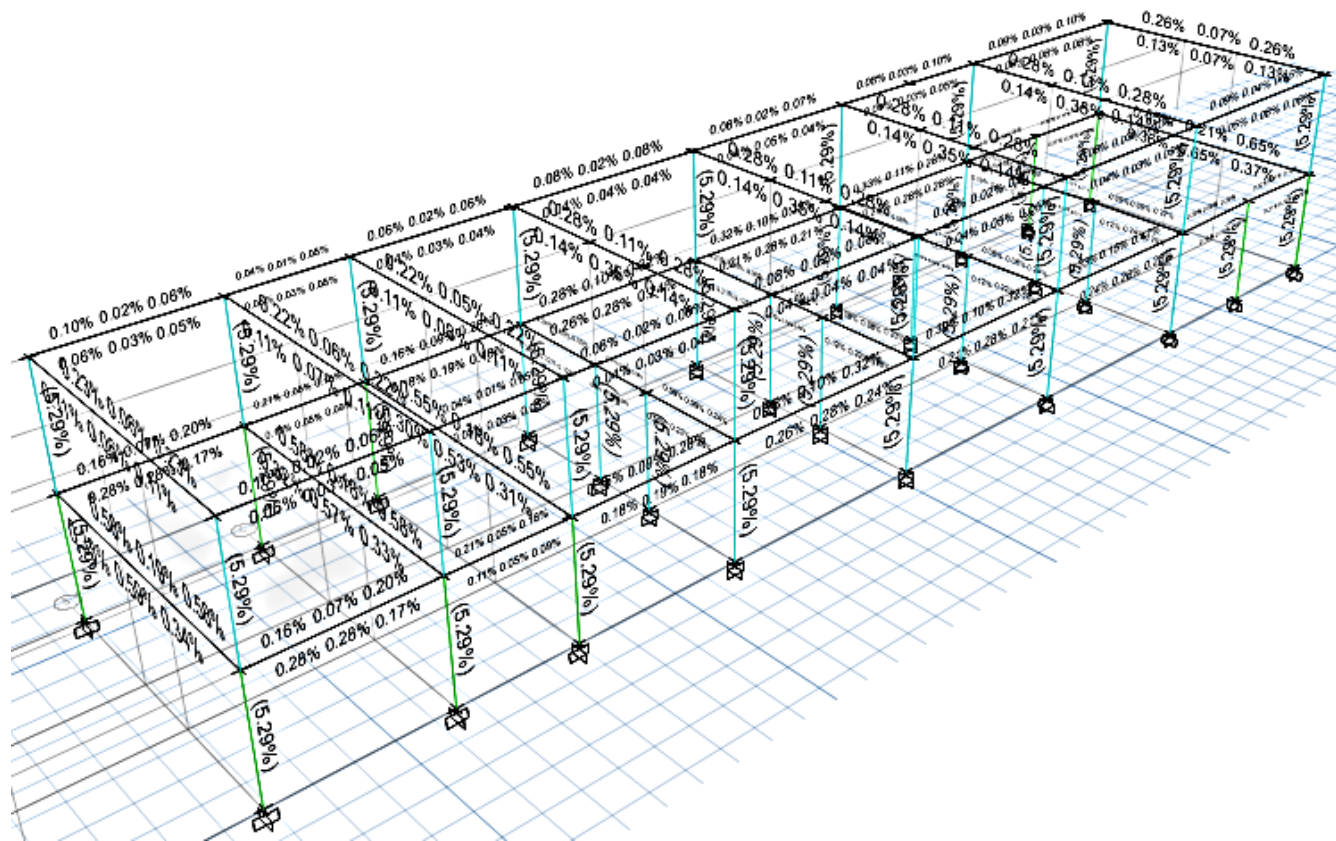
Cuantía del acero de refuerzo longitudinal de la zona B, ETABS 2015. Fuente: Autor.
